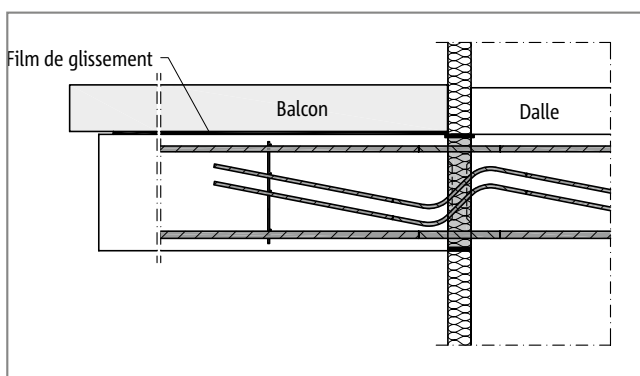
Schöck Isokorb® T Type B : Construction de balcon avec poutrelles en porte-à-faux (balcon préfabriqué)
